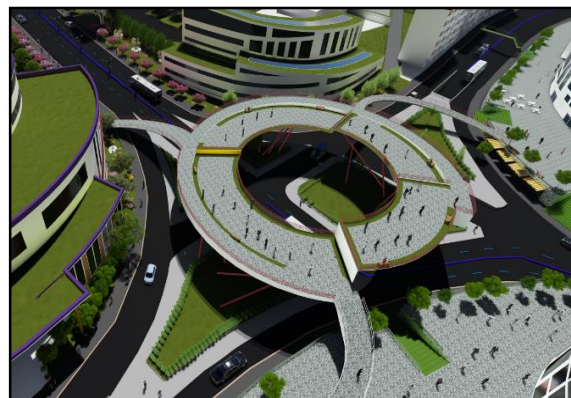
Vue en 3D sur Placette surélevée au niveau de nœud 20 avril
